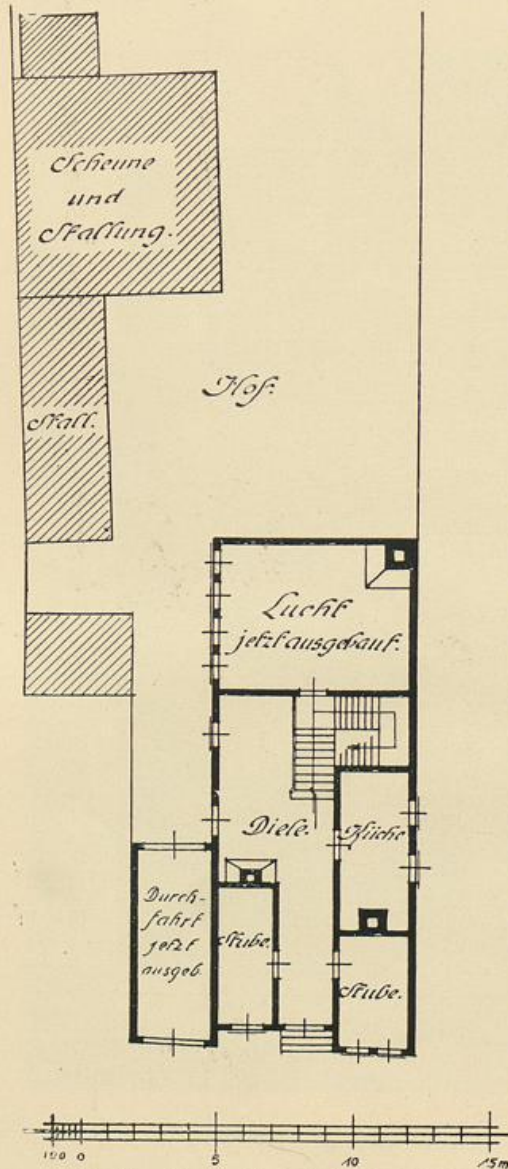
Hameln, Baustraße 7, erbaut 1609.
